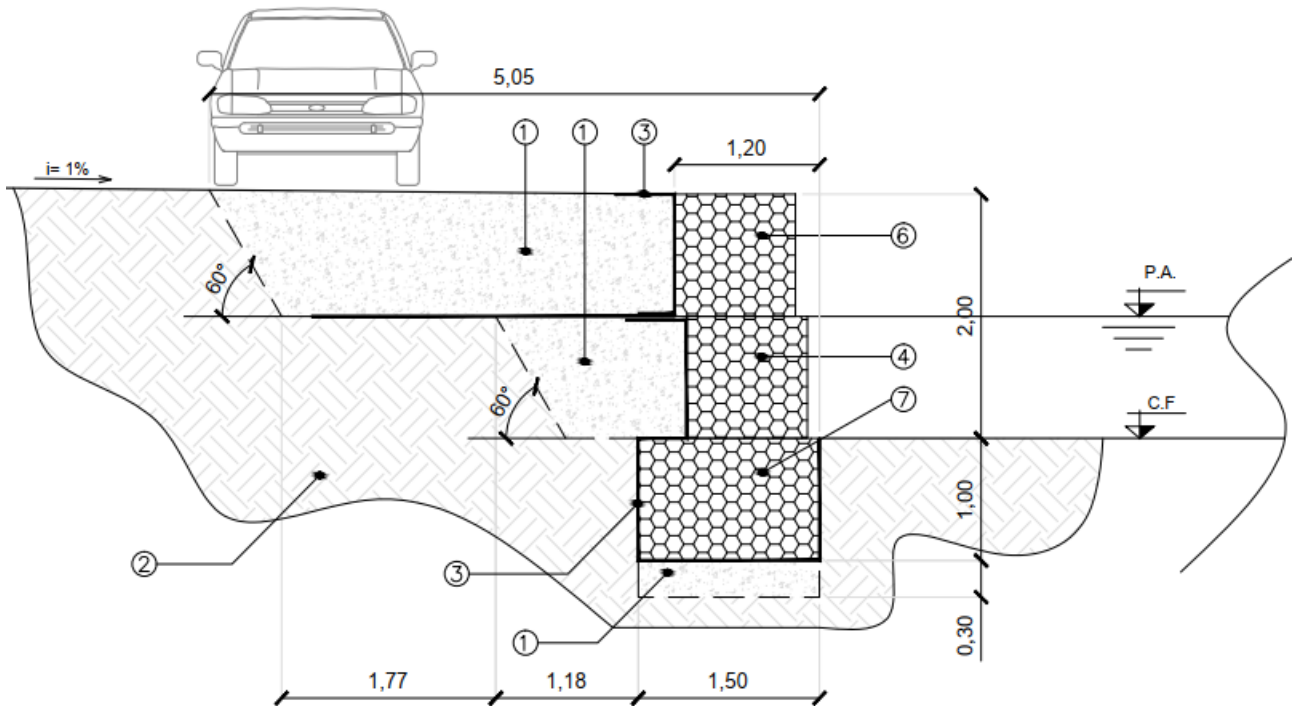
Perfil transversal tipo (T-T), muro vertical, esquema que continúa hasta terminar la obra.
